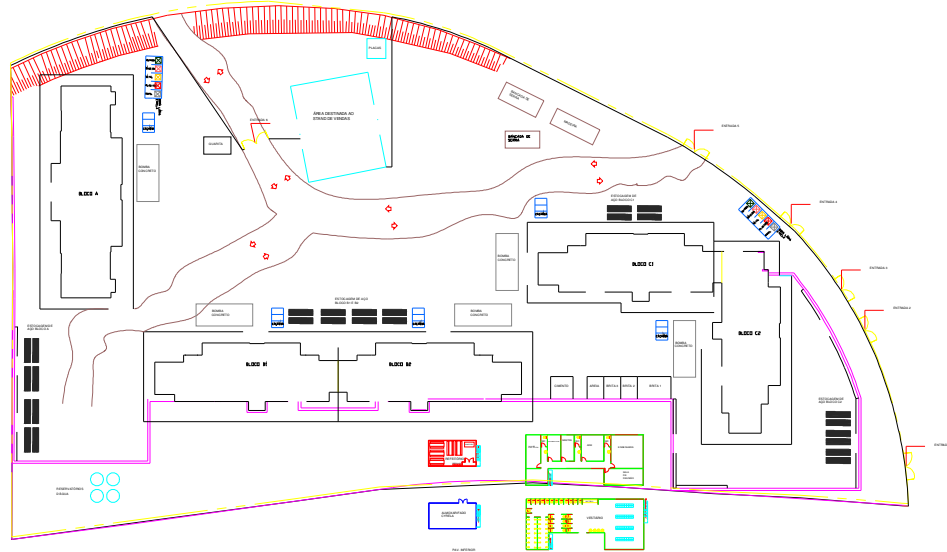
Arranjo de canteiro da fase inicial, indicando os locais das torres e as vias de acesso de caminhões.
